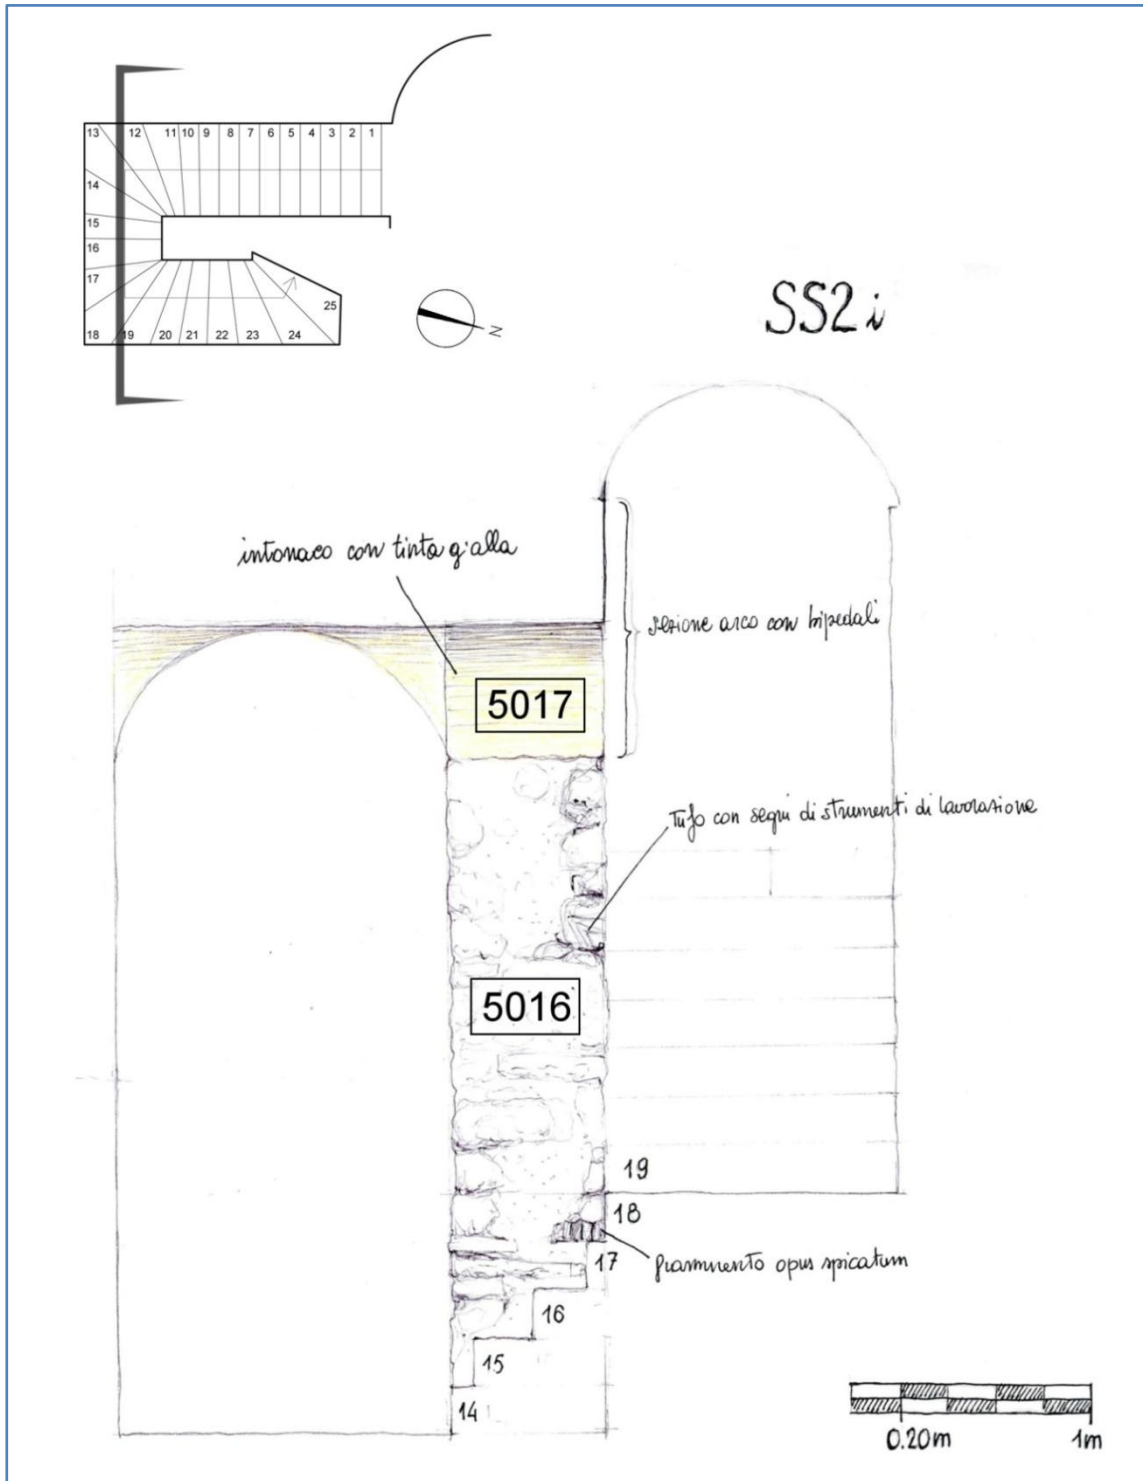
Prospetto sud seconda rampa lato interno (SS2i). Disegno D'Ippolito.
